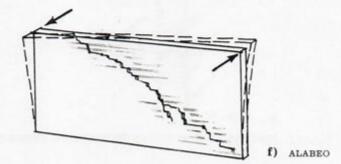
FISURAS EN LOS MUROS DE OBRA DE FABRICA
